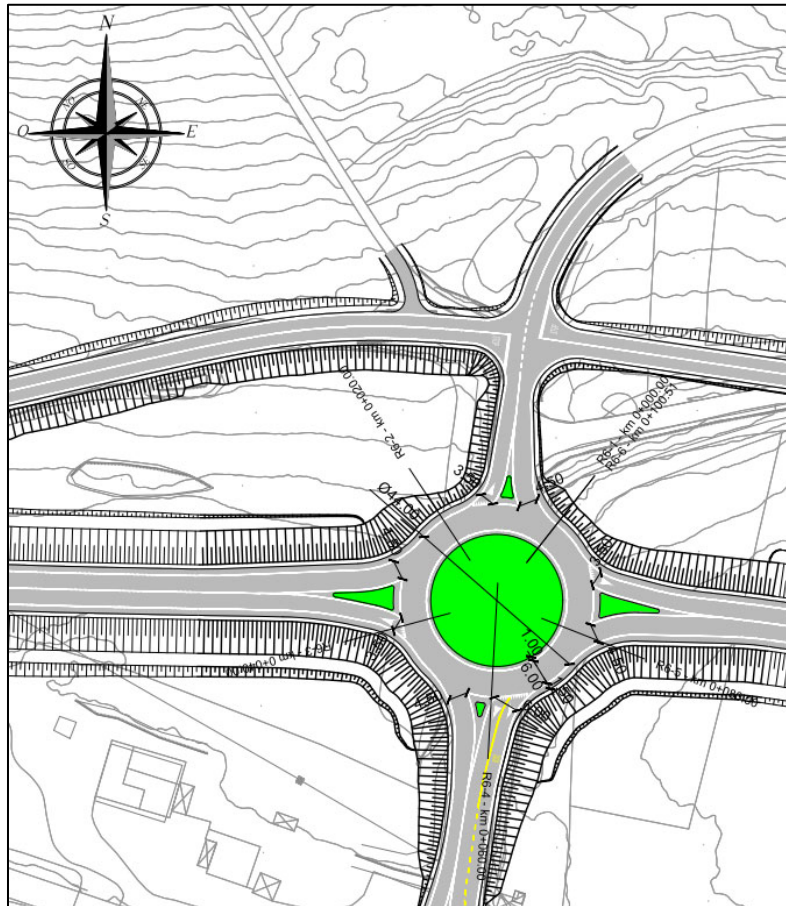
Estratto della planimetria di progetto della rotatoria 6
